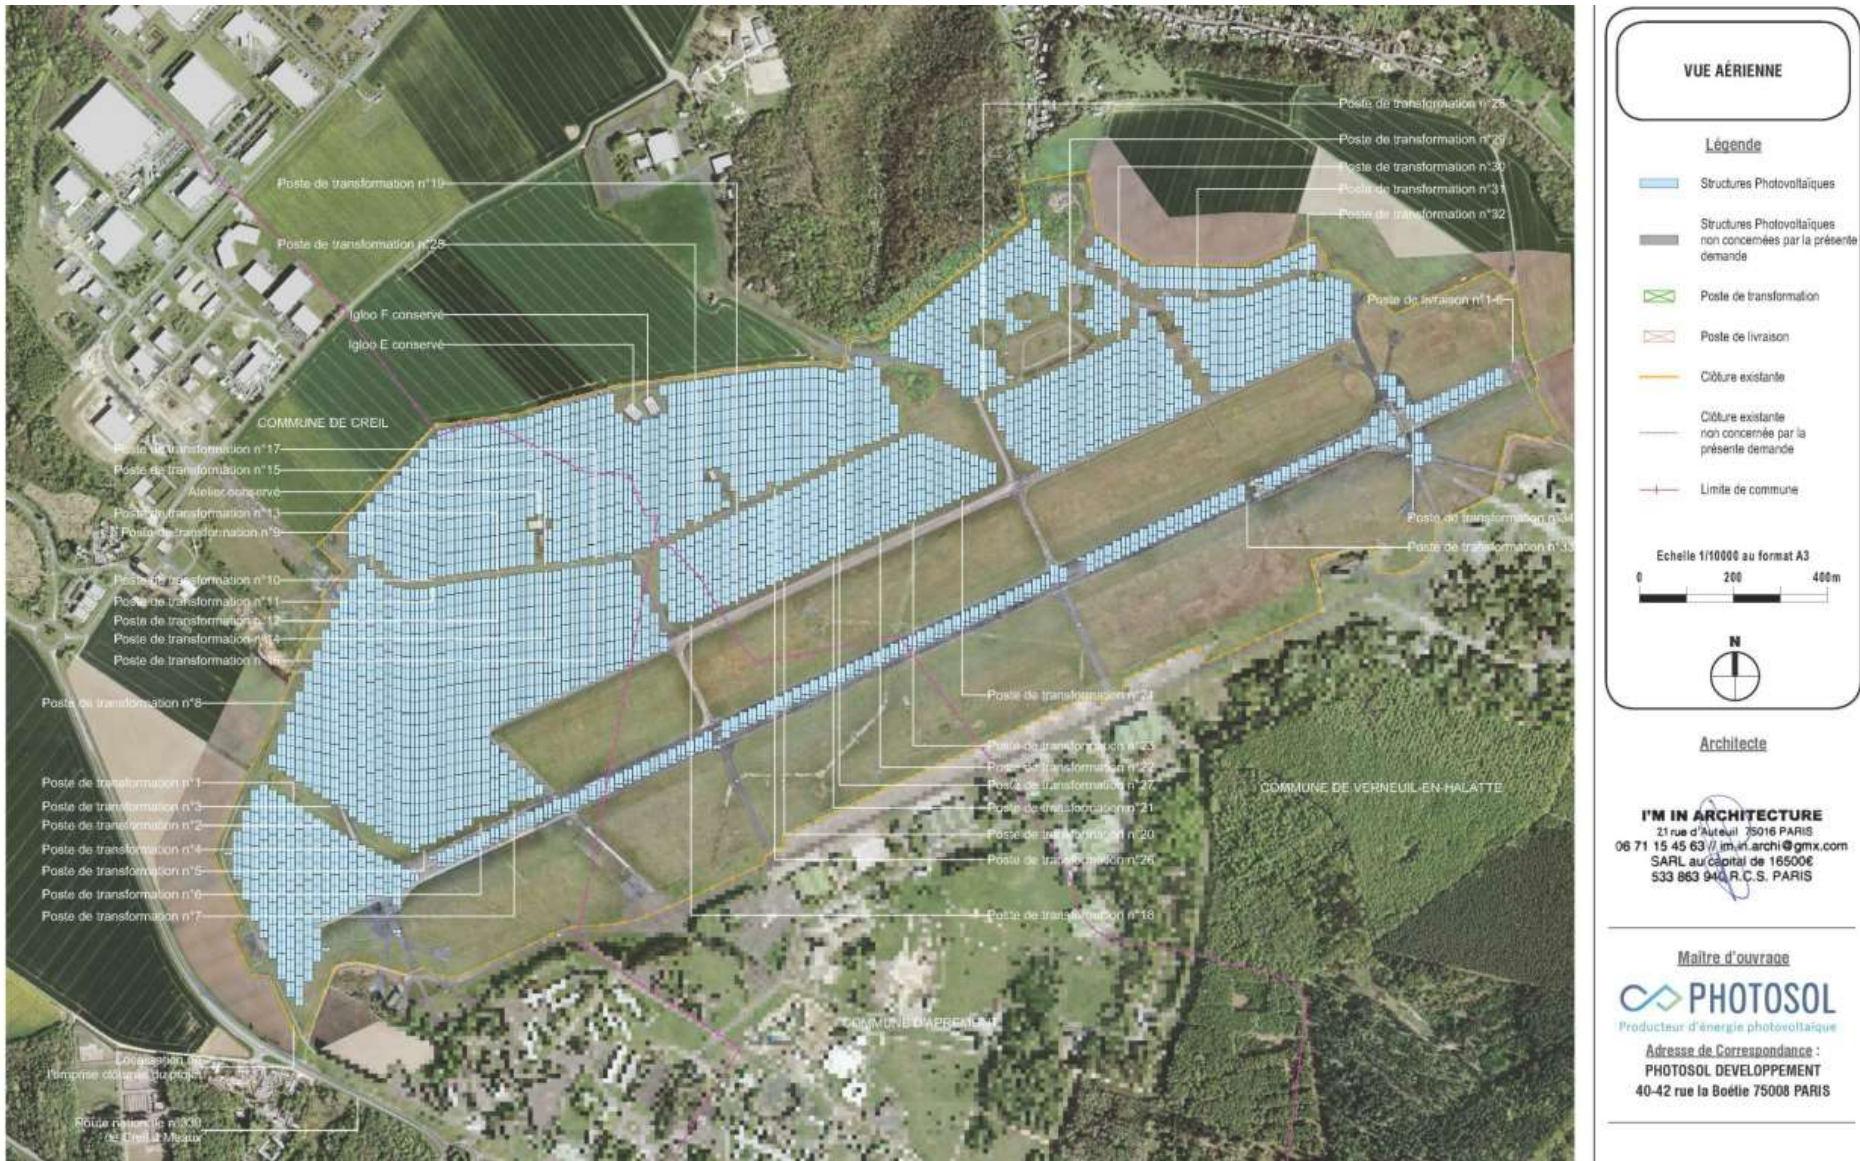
Plan de masse de l'installation (source : PHOTOSOL)
